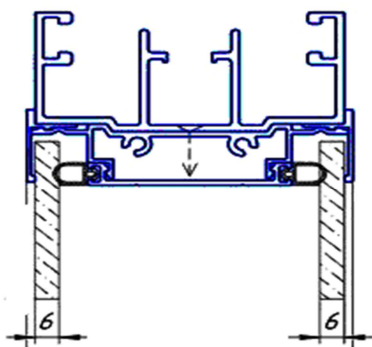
Верх офисной перегородки без крепления к потолку
